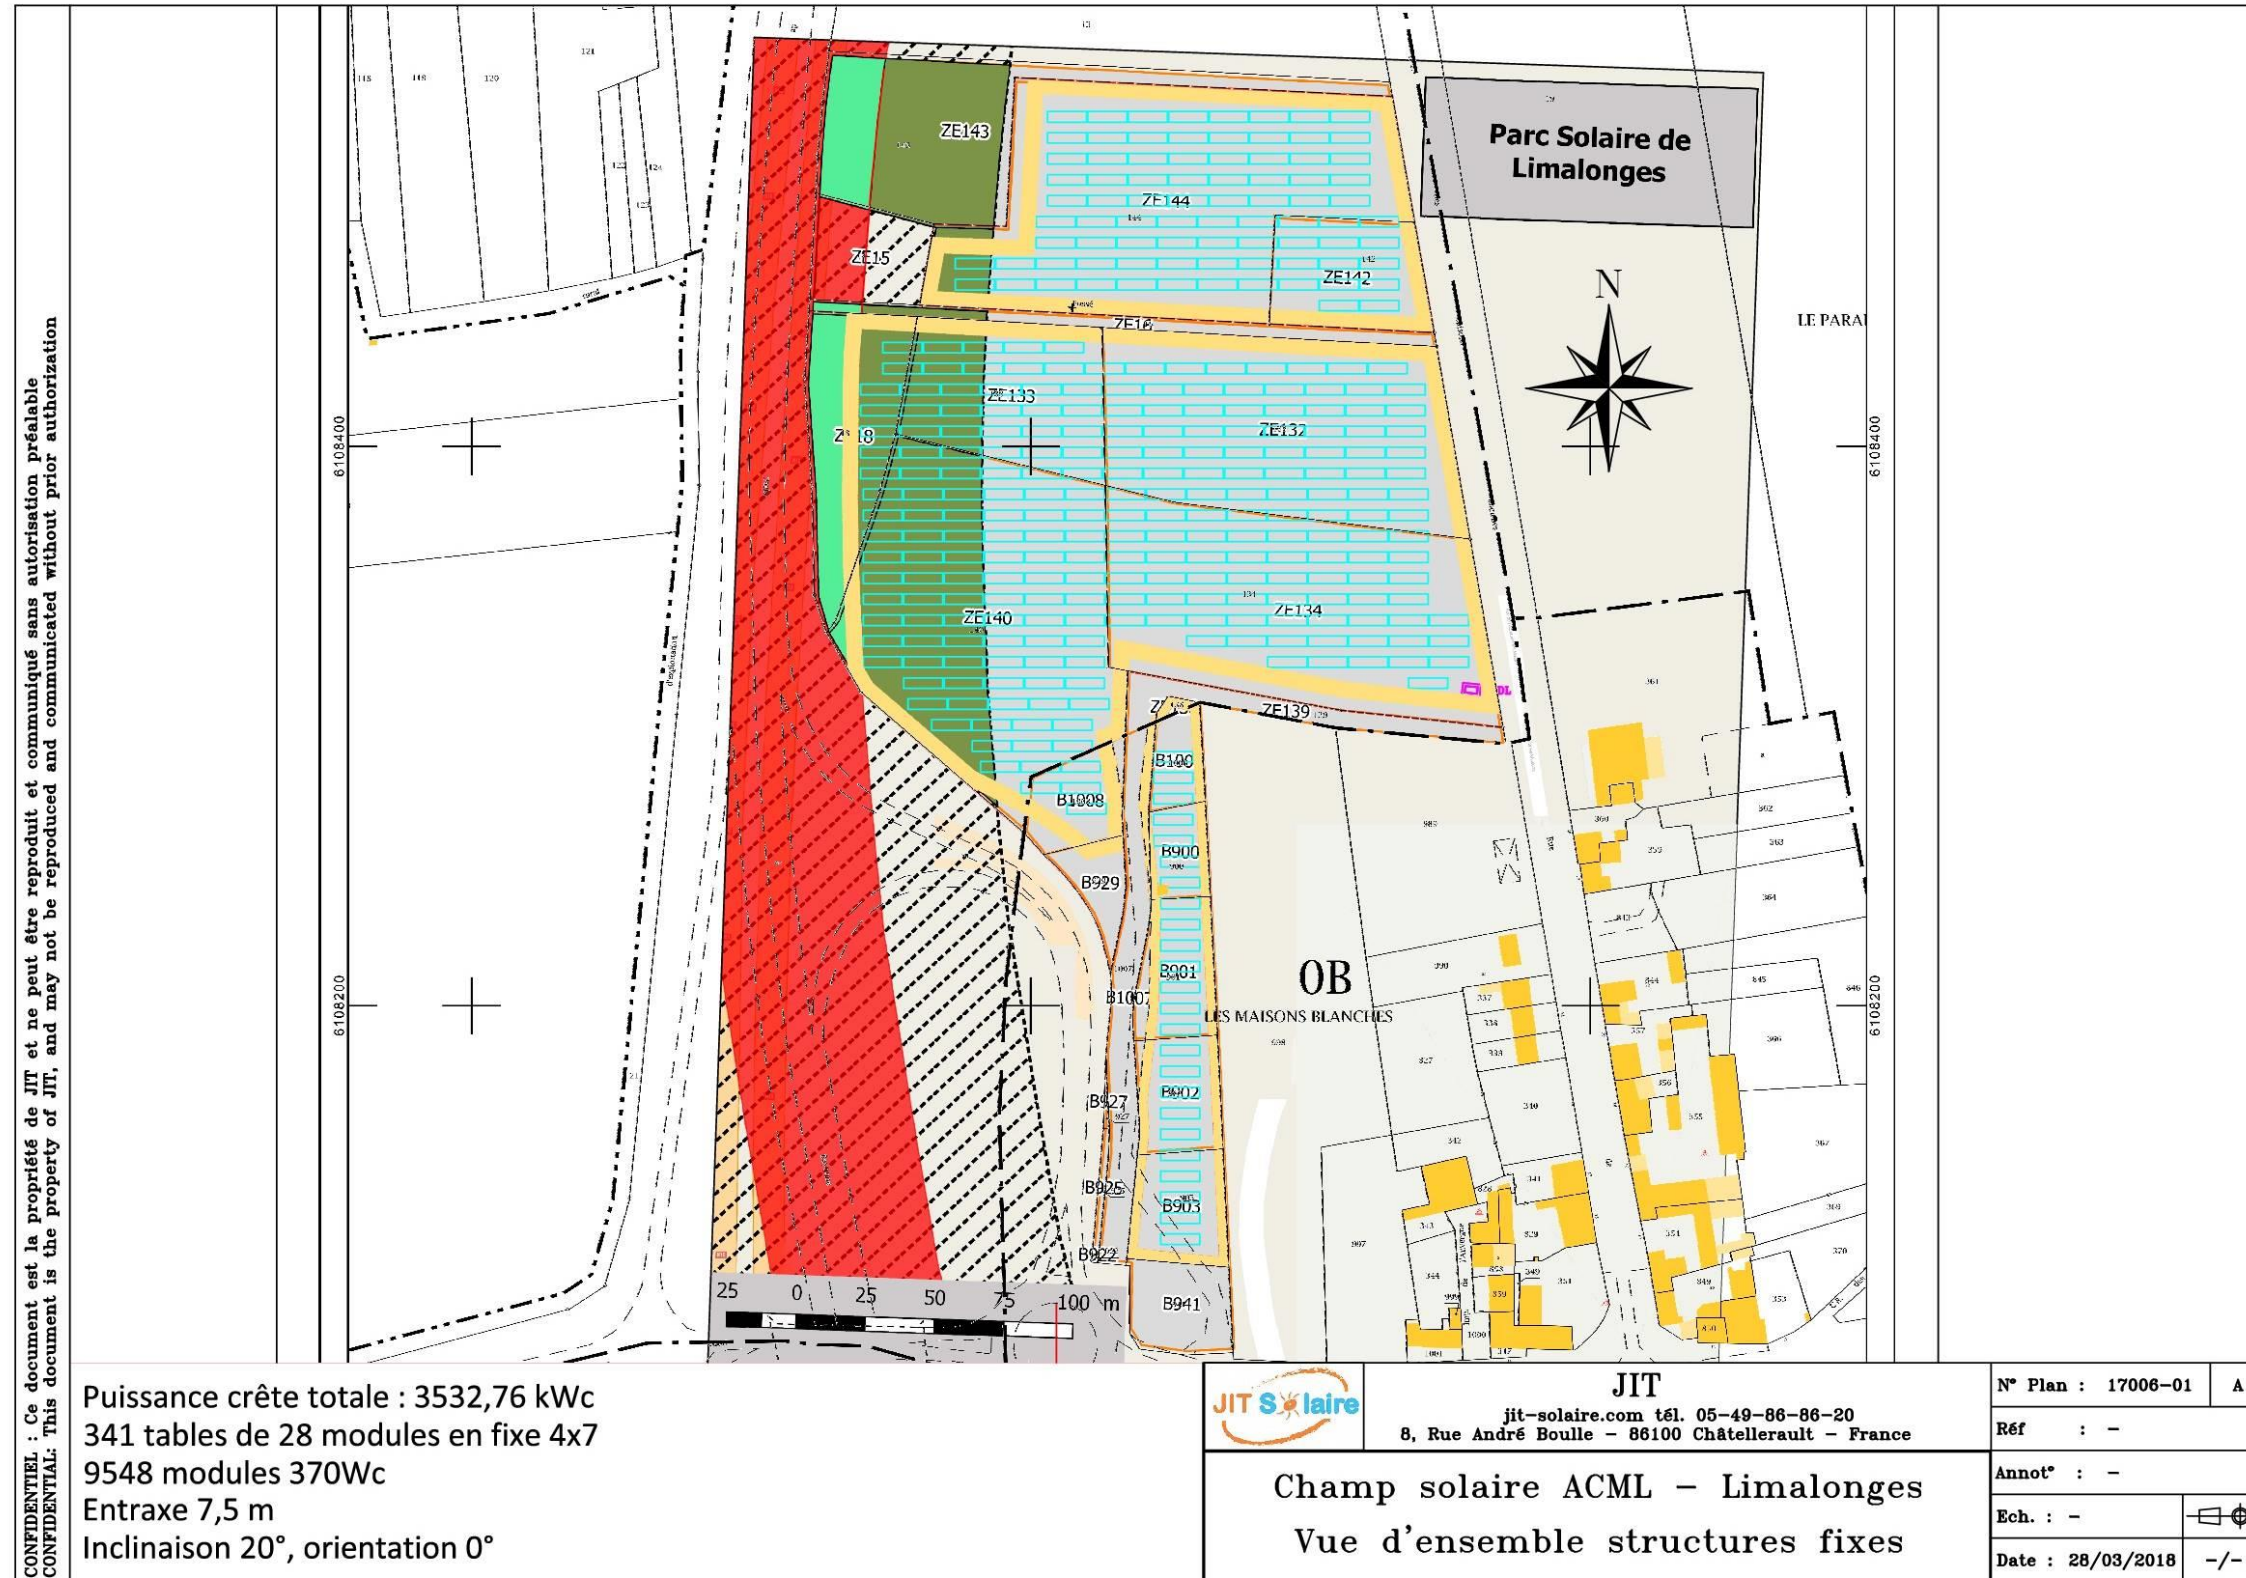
Plan d'implantation du projet sur le site (variante 1)
